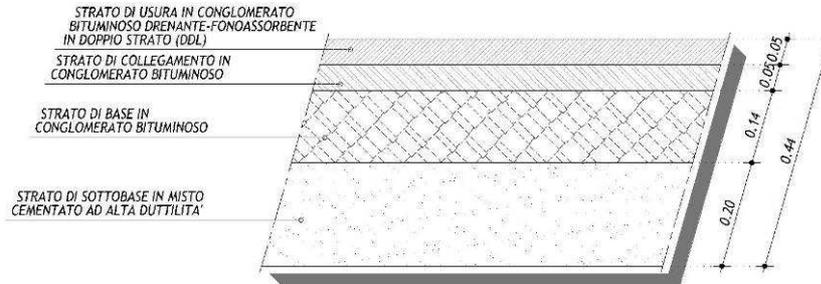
SEZIONE TIPO SU VIADOTTO
